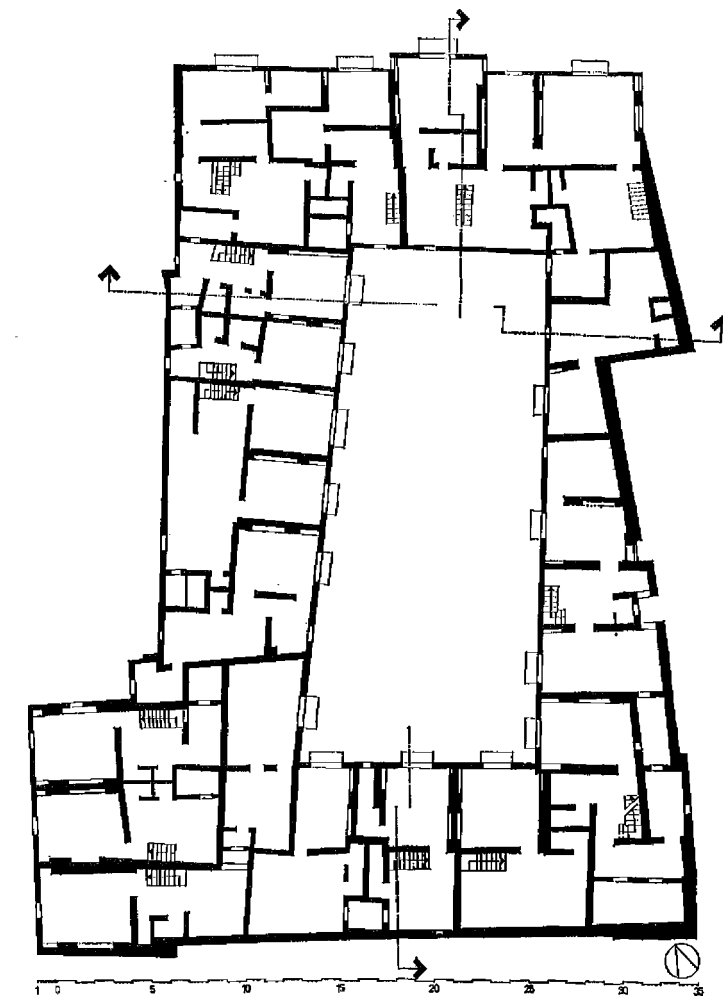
Kairo, Wakalat al-Bazar'a, Grundriß — viertes Obergeschoß
